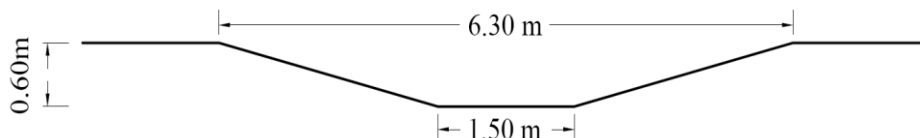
Secțiunea transversală propusă a canalului de racordare (original)
